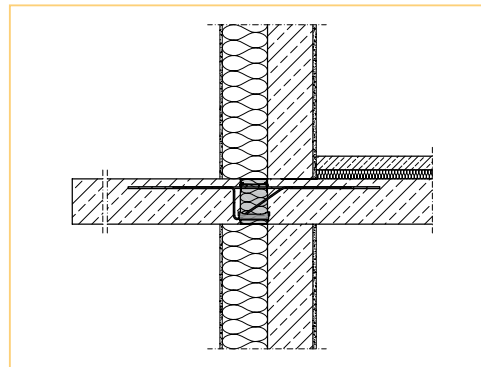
Darstellung einer Schnittzeichnung mit detailliertem Schöck Isokorb® Modell
